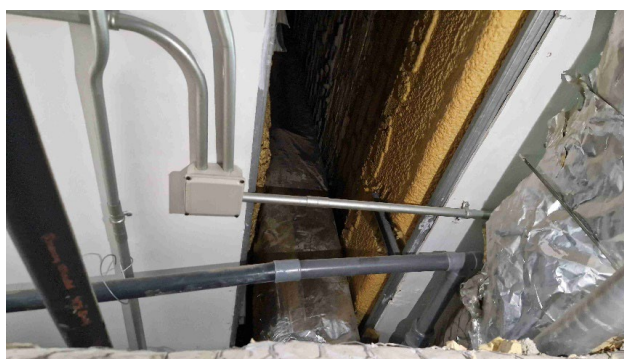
A. Muro técnico para subida de conductos en los talleres.
